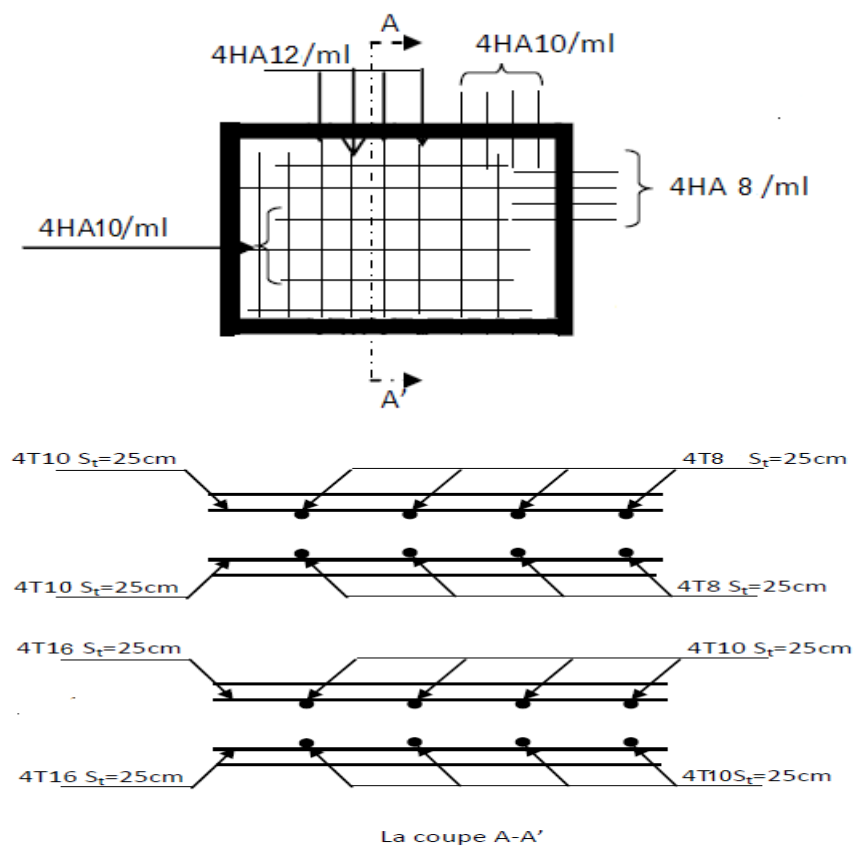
Schéma du ferrailage de la dalle pleine sur laquelle la coupole est ancrée.
